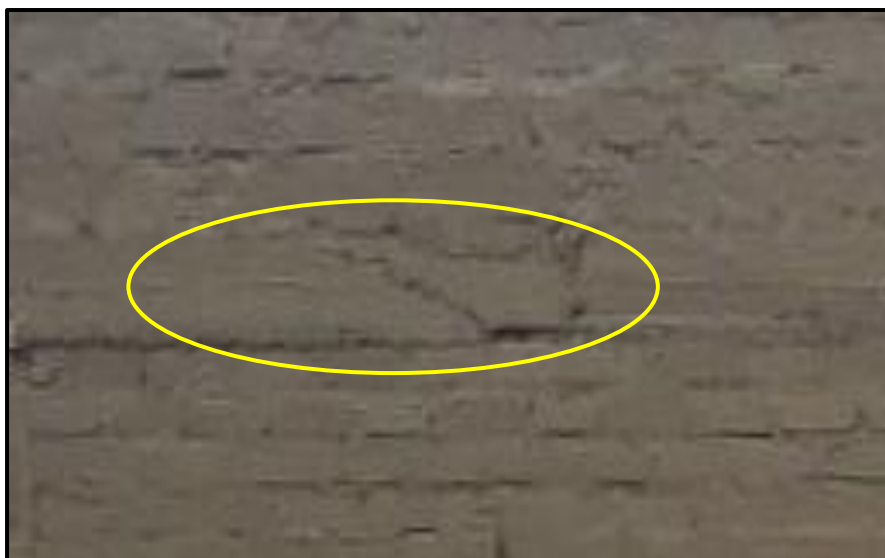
Unidad muestral 22, presencia de fisura en la viga.
